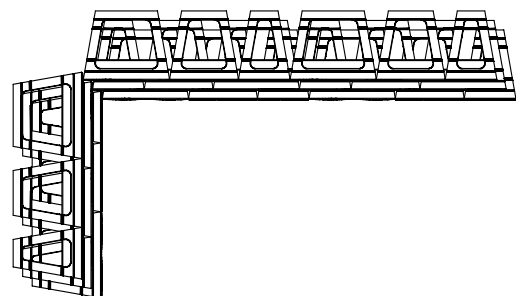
Grundriss Innenecke mit Rücksprung 5,5 cm
